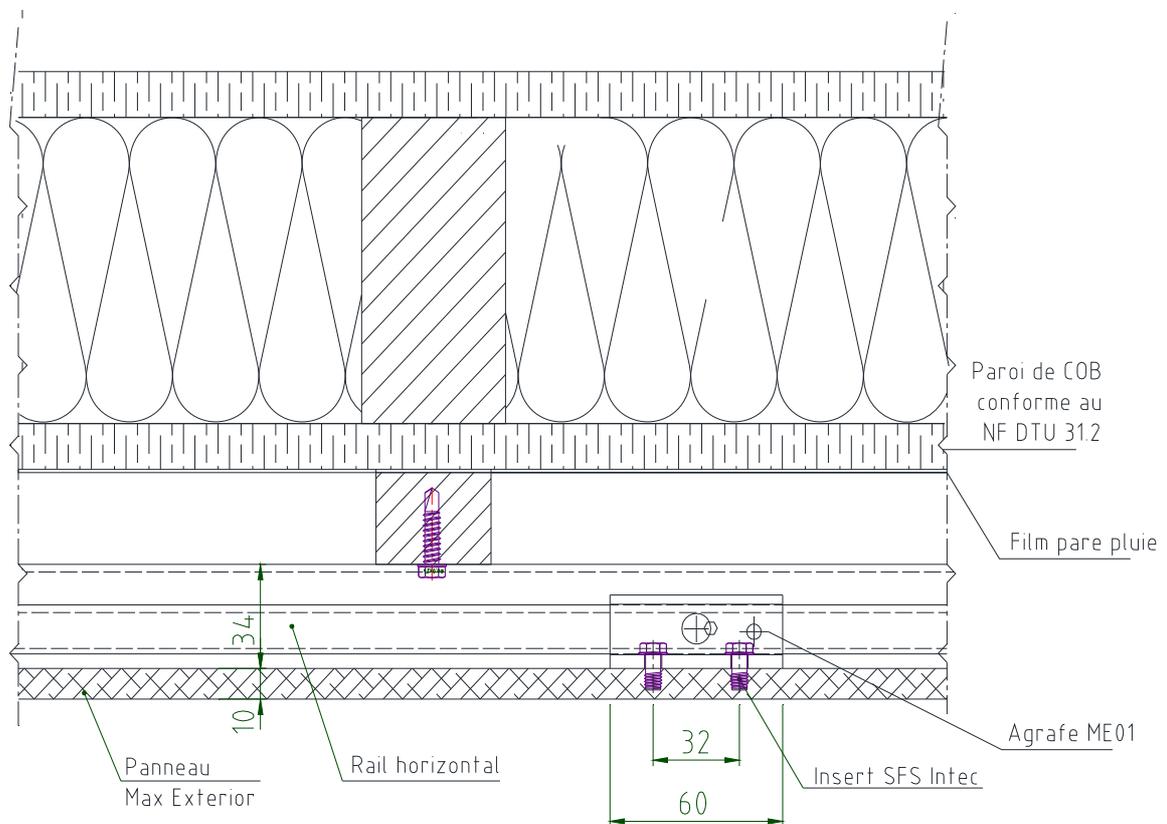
Détail fixation du rail sur tasseaux (Coupe horizontale)
